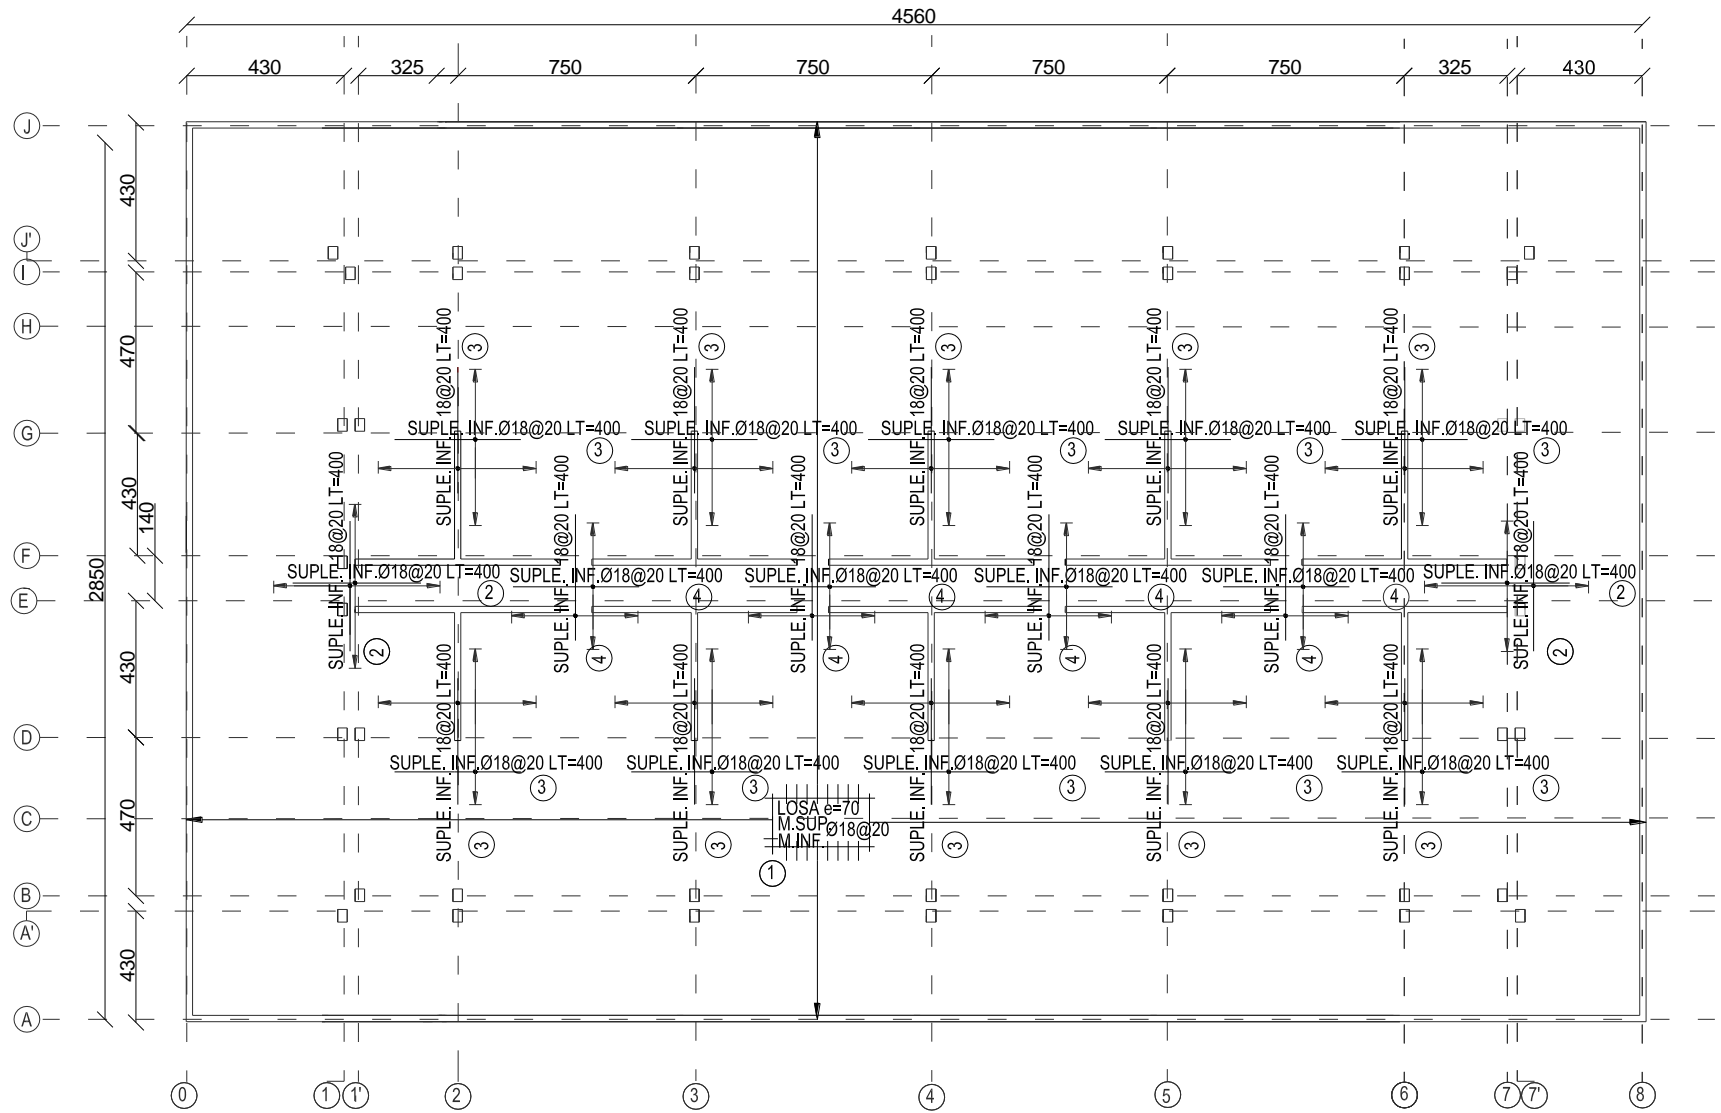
Planta losa de fundación armadura superior e inferior edificio aislado.
